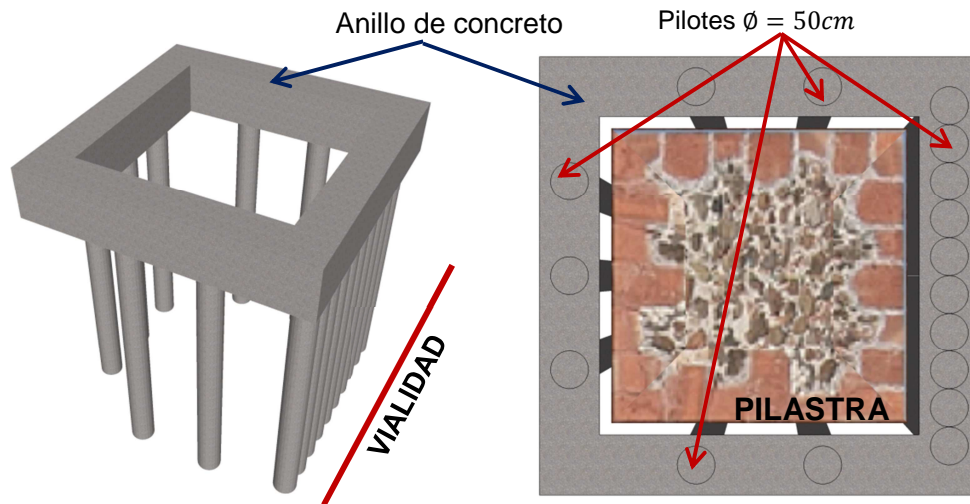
Sistema de pilotes para confinamiento de la zapata.
